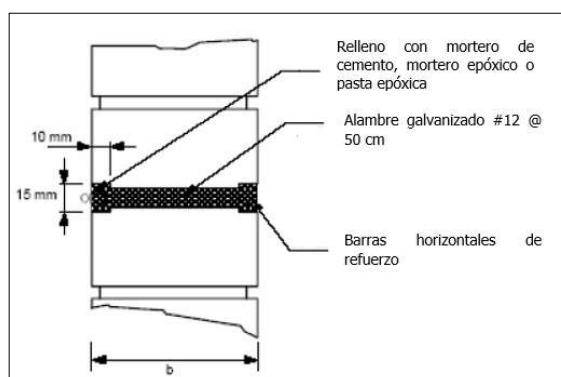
Inserción de barras de refuerzo en las juntas de mortero (Tomada de Sociedad Mexicana de Ingeniería Estructural, “Rehabilitación sísmica de edificaciones de mampostería para vivienda”, Jorge Ruiz García, Queretaro 2007).
